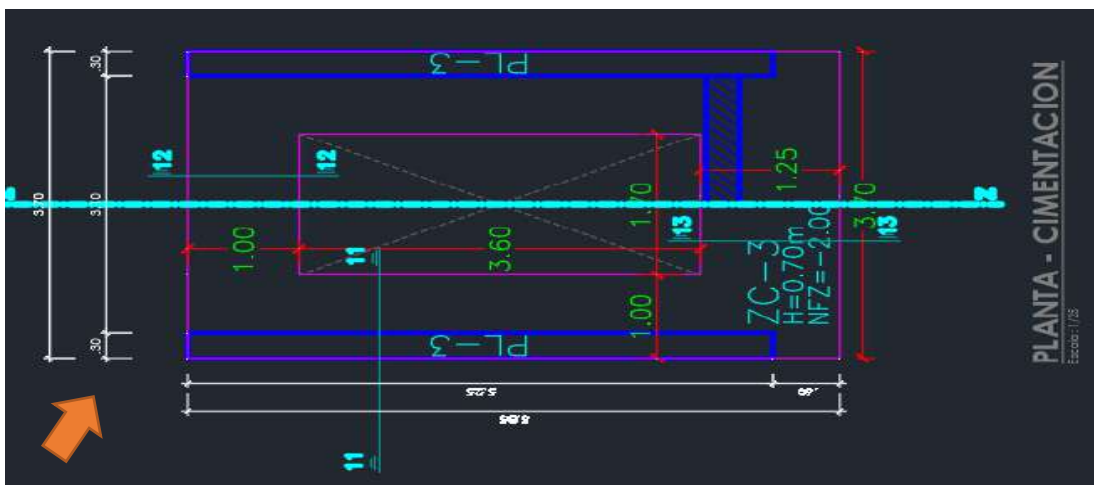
Documentación faltante respecto a detalles estructurales de columna CA-3.
